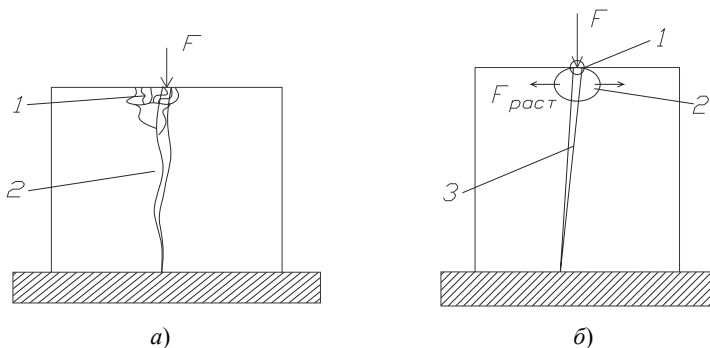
Испытание модели стены, армированной фибрами, под действием сосредоточенной нагрузки:
